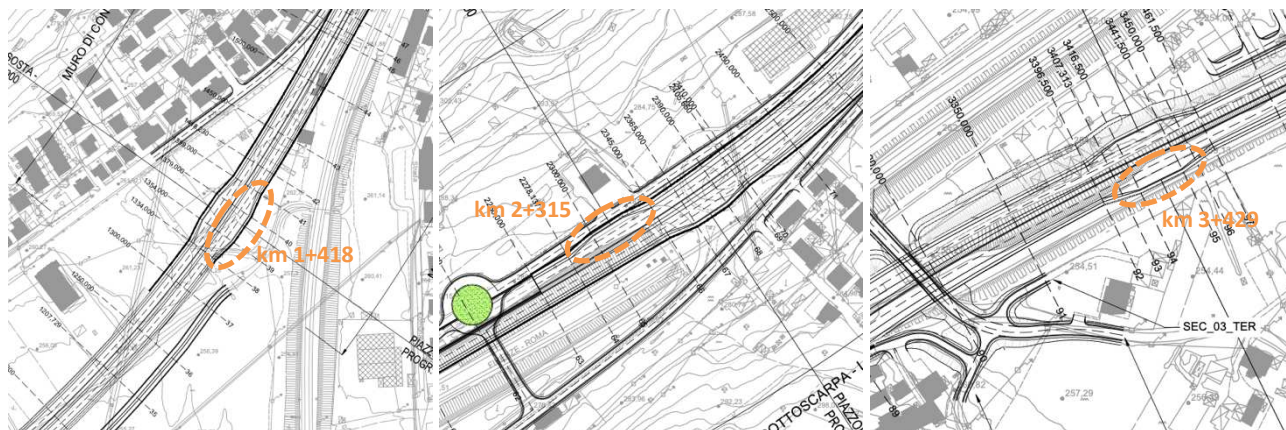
Stralcio planimetrico delle tre piazzole considerate critiche
